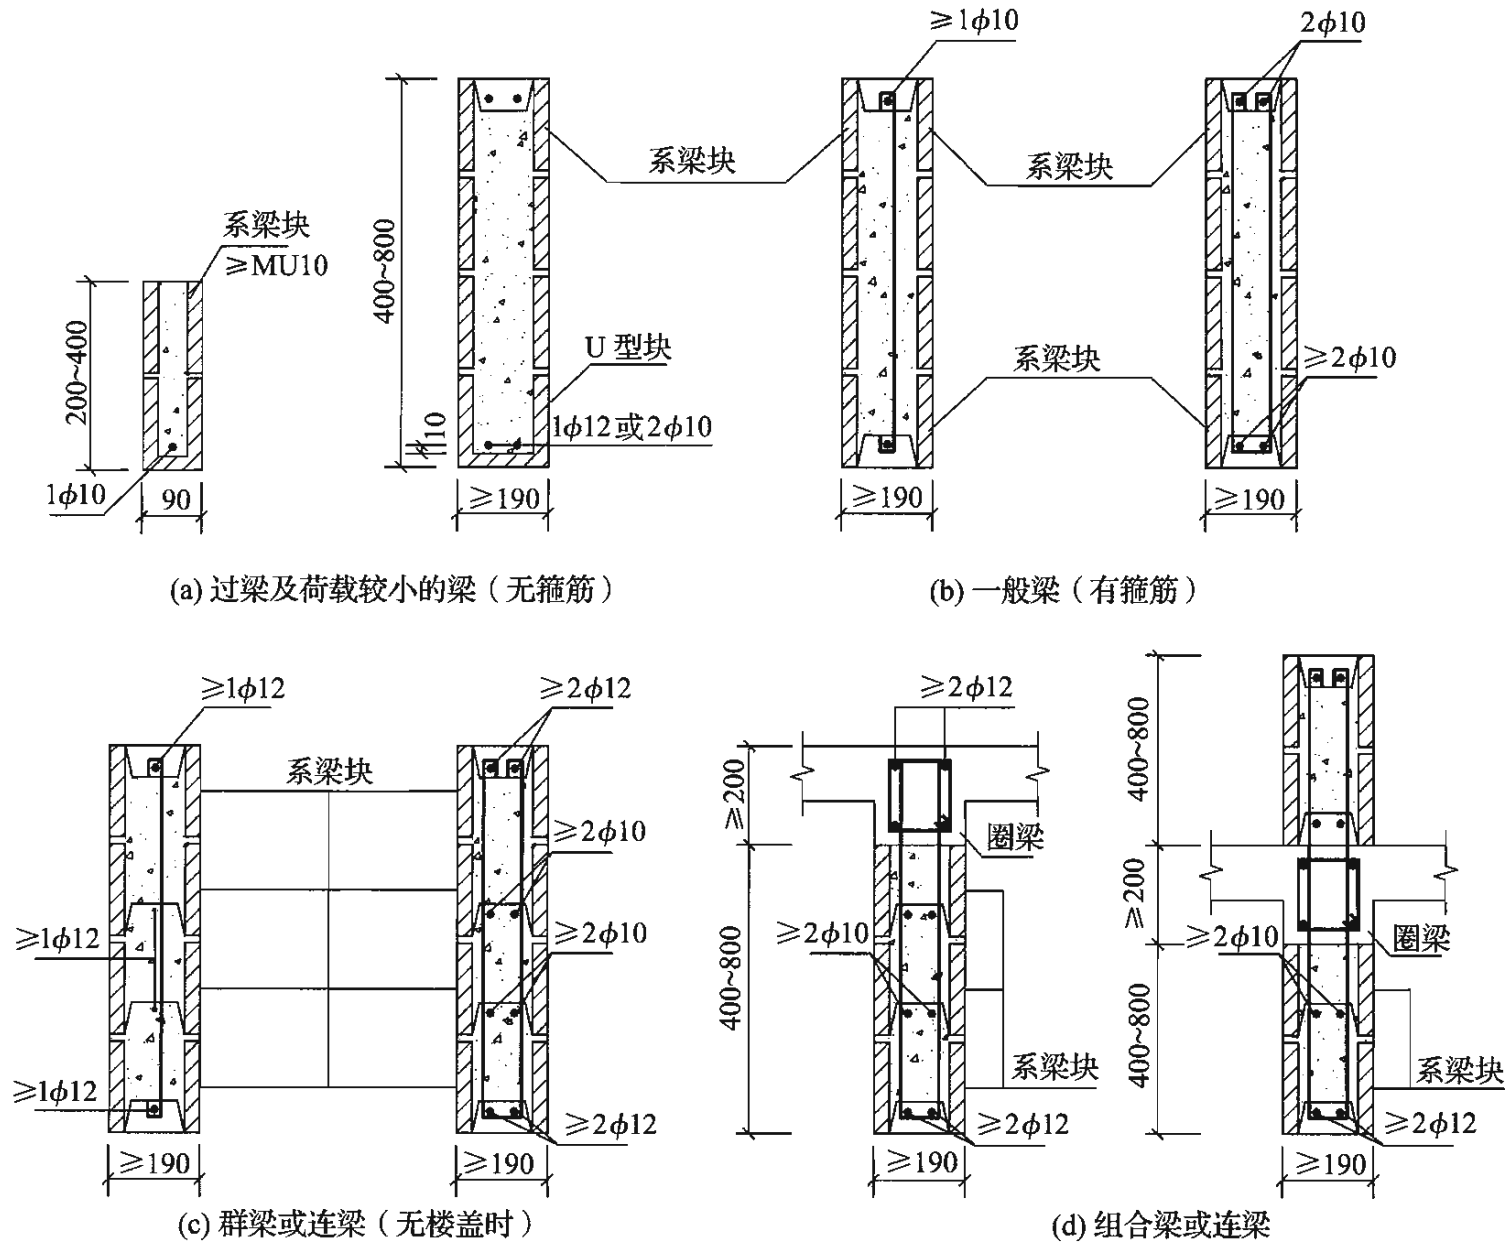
配筋砌块梁截面及配筋方式示意图
